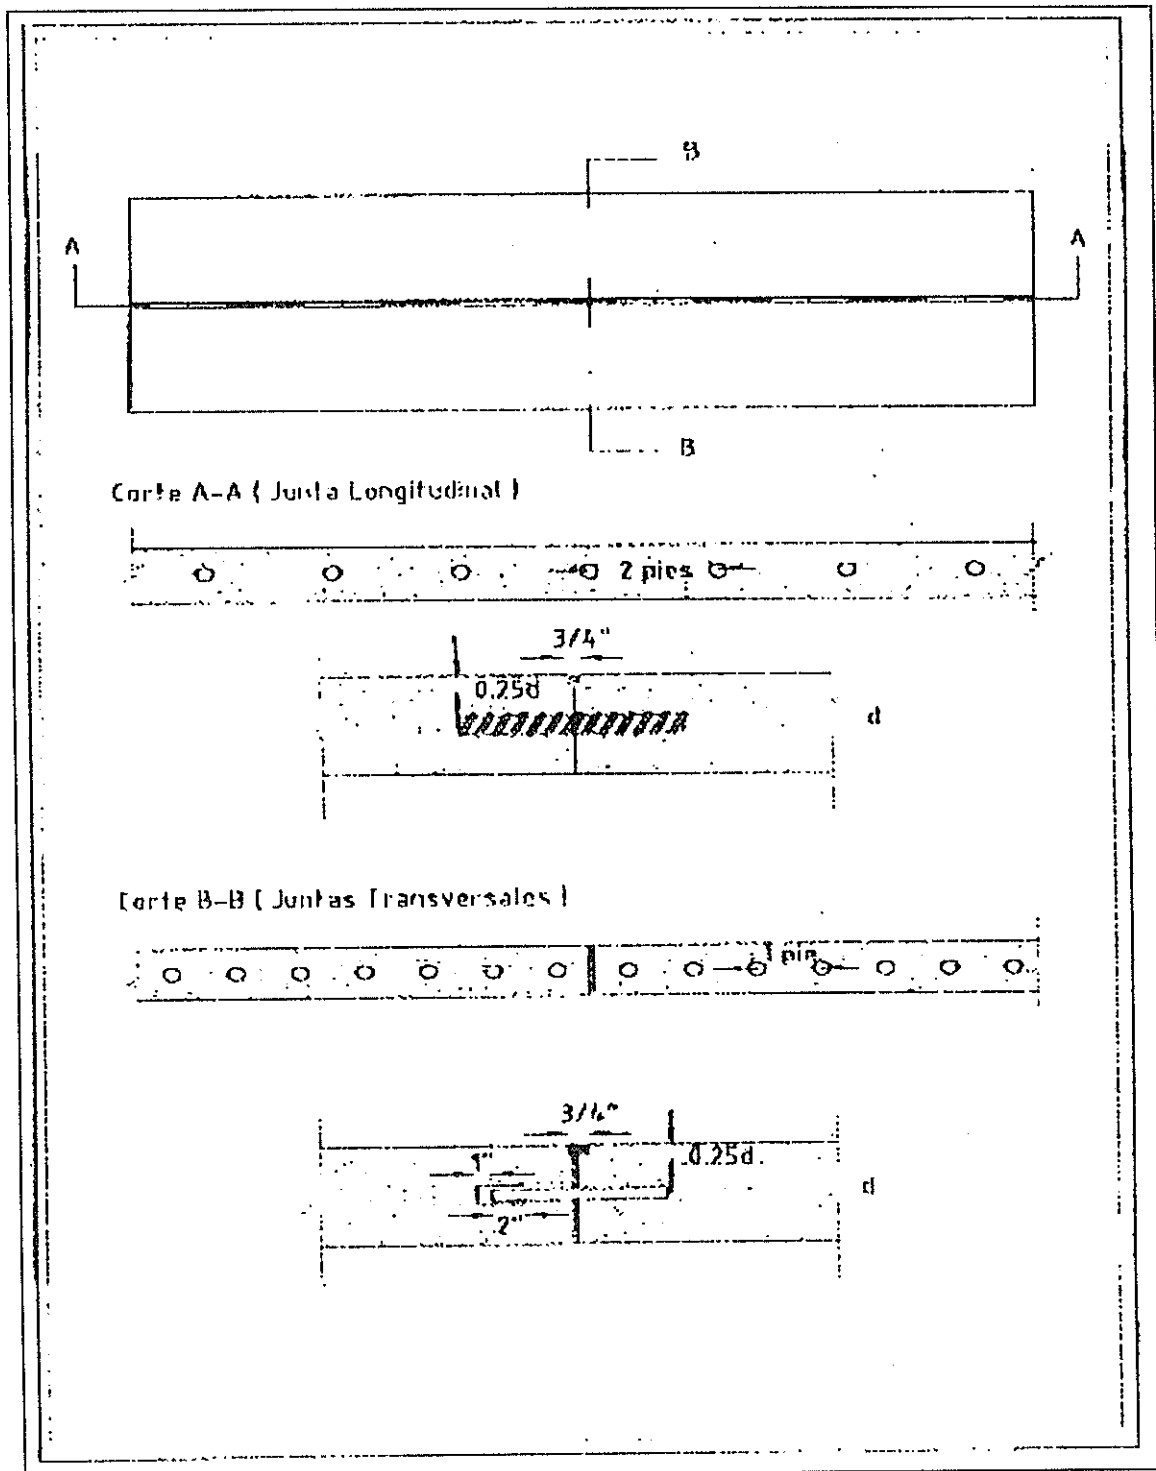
JUNTA LONGITUDINAL Y TRANSVERSAL
